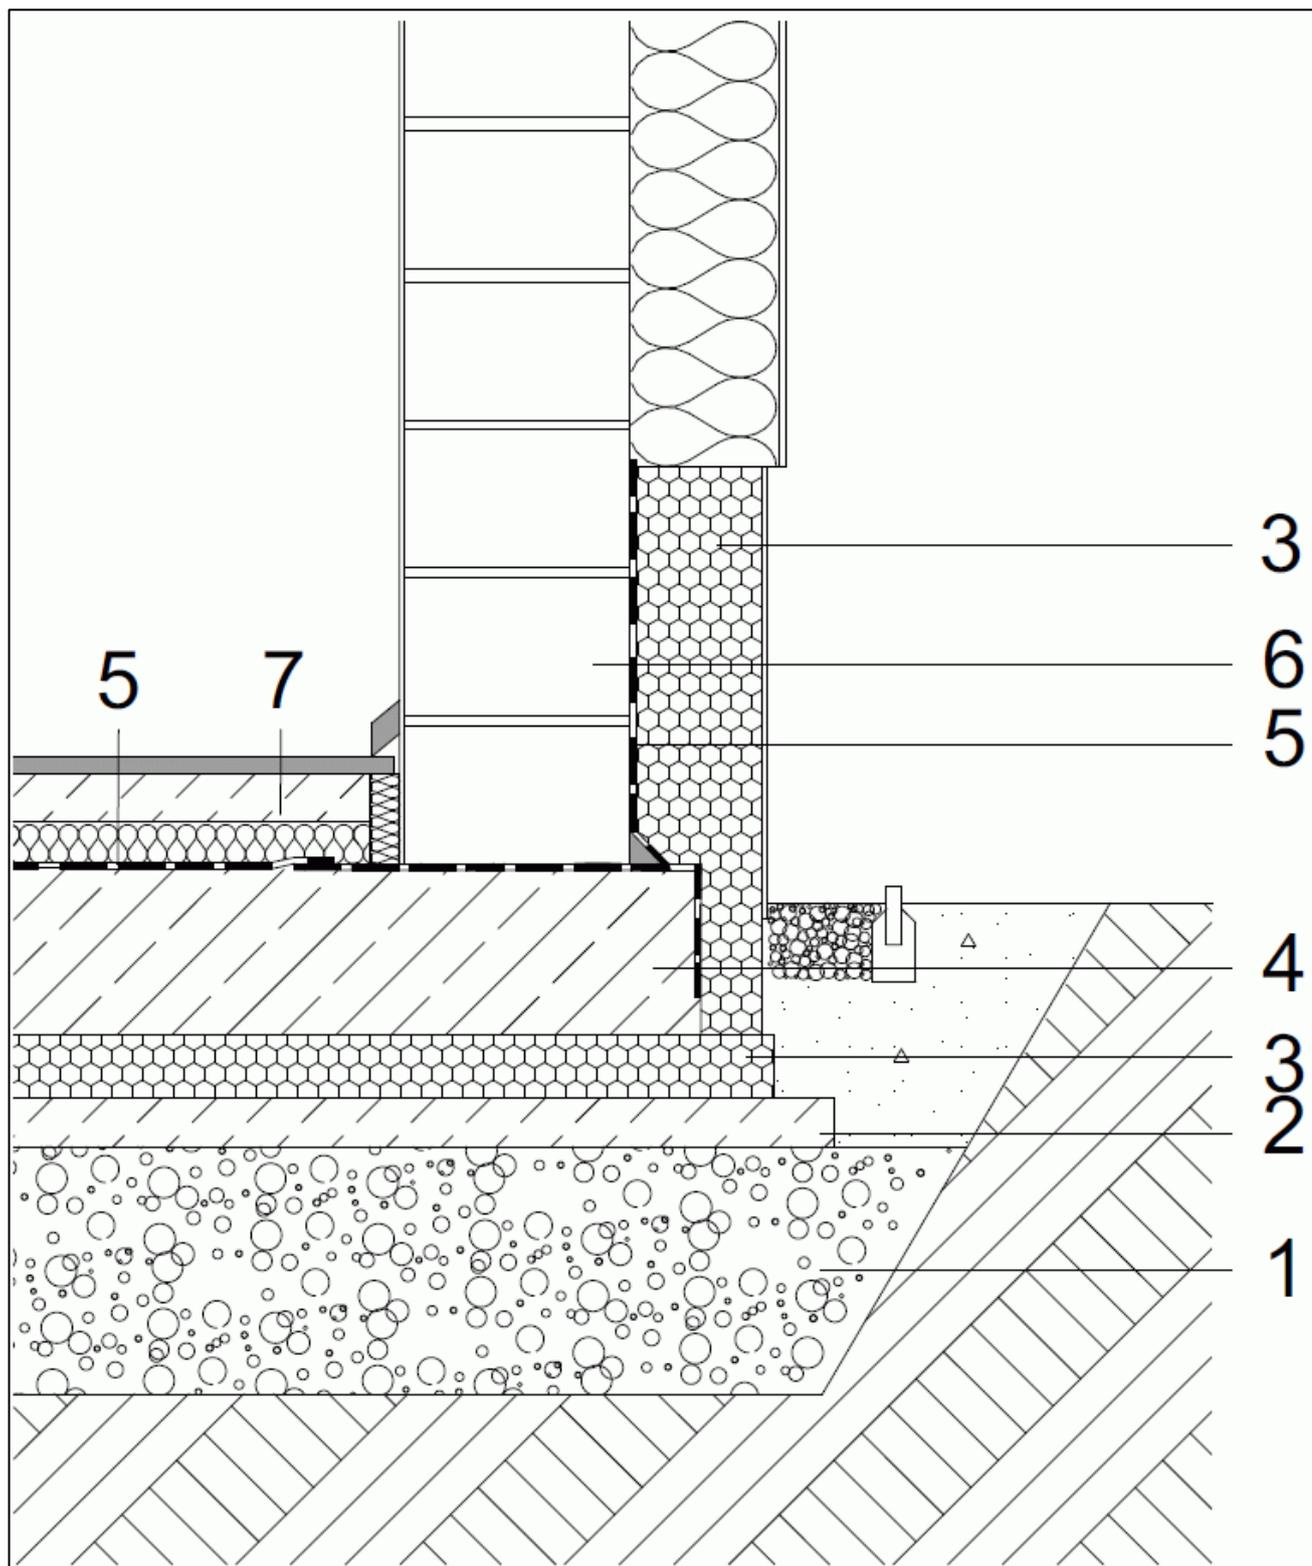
Anschlussdetail Außenwand / Bodenplatte mit Abdichtung nach DIN 18533
